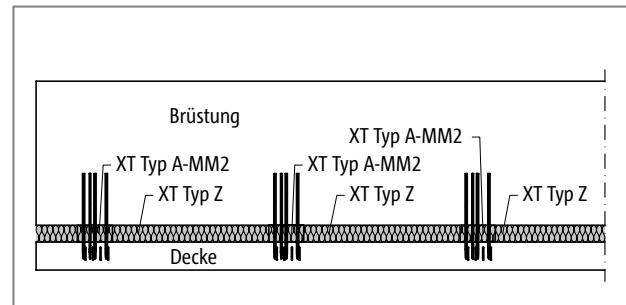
Schöck Isokorb® XT Typ A, Z: Brüstung (XT Typ A-MM2)
